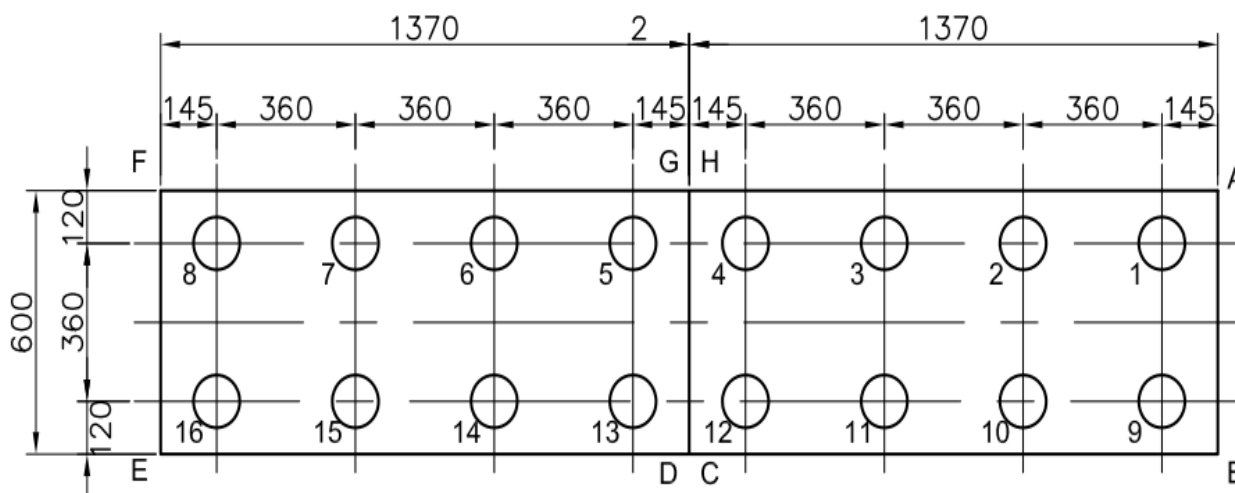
Plan de disposition des pieux sous les deux semelles
